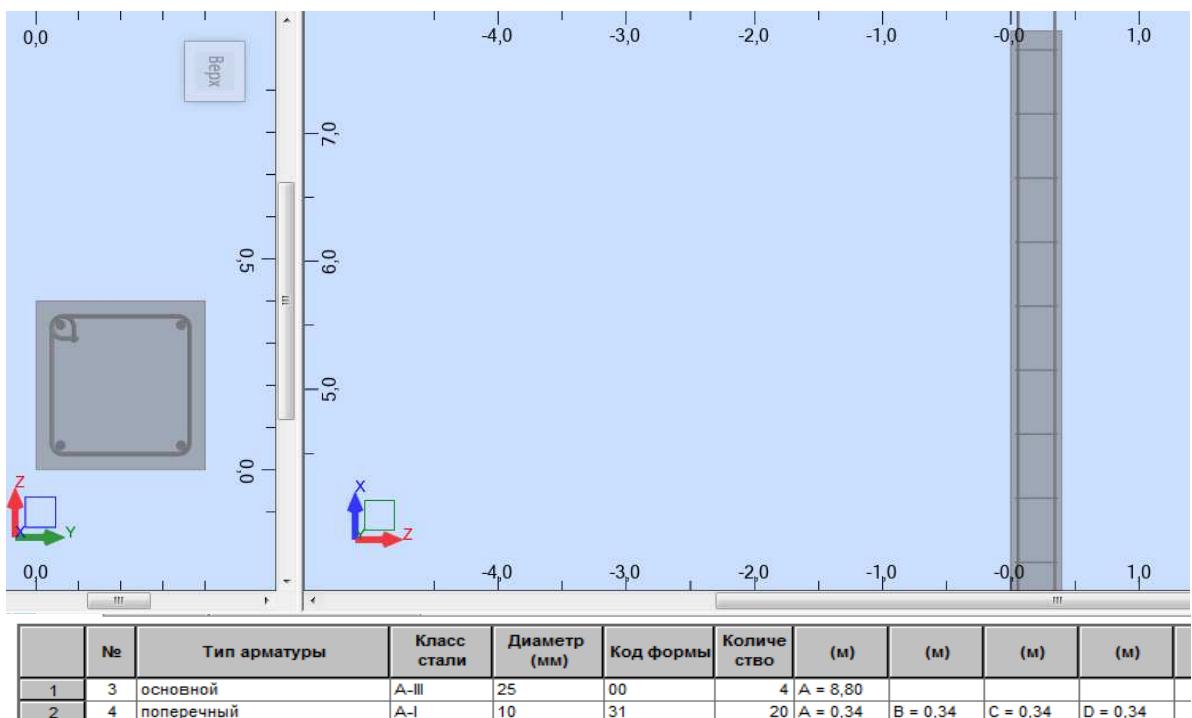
Подбор арматуры и раскладка ее по колонне
